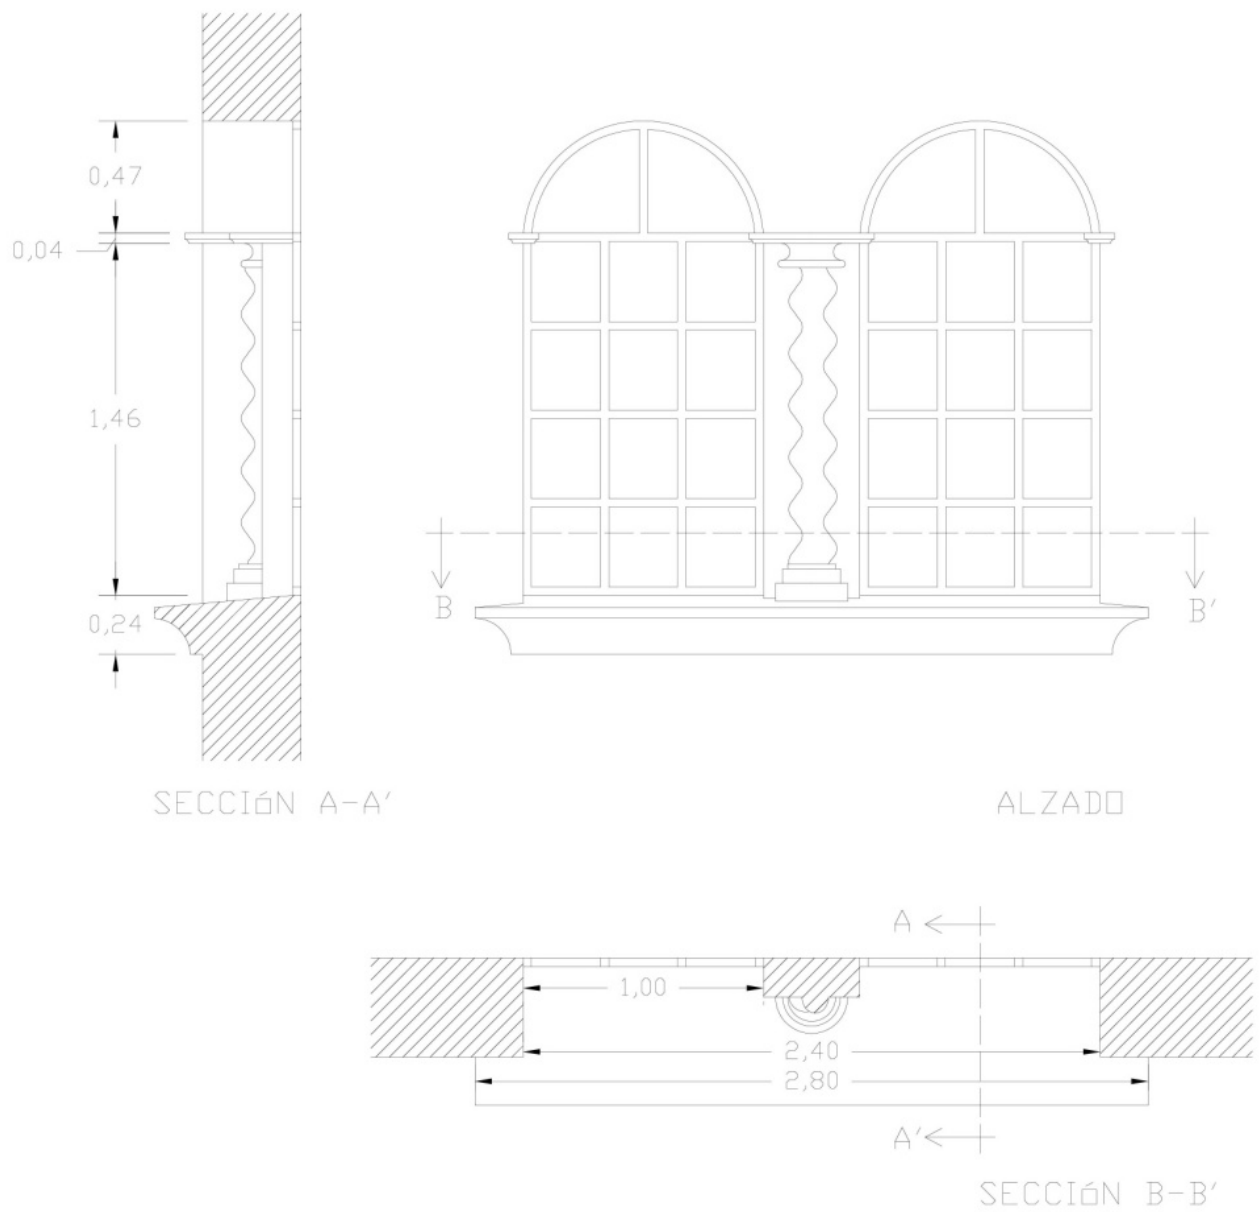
Detalle de las ventanas de la fachada Oeste en planta baja.
